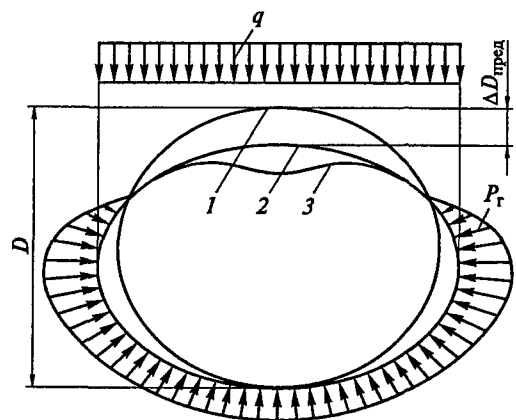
Расчетная схема деформирования гибкой стальной трубы под действием нагрузки  $q$  и упругого отпора грунта  $P_r$ :
